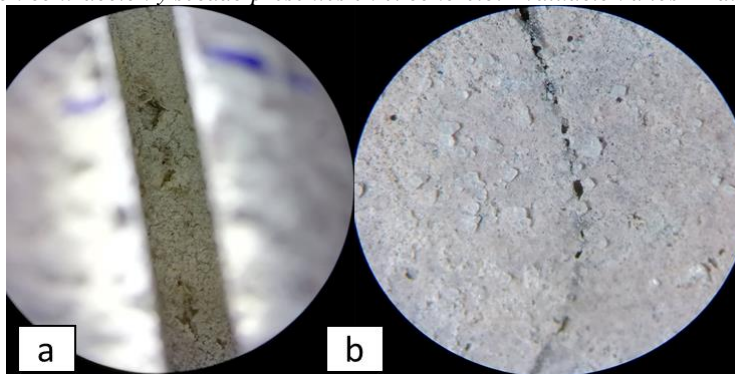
Probeta Piedra 4 2b 2. (a) vista interna de la fisura inducida (b) vista de discontinuidades y fisuras con contracción y secado presentes en el concreto. Evaluación a los 28 días.
